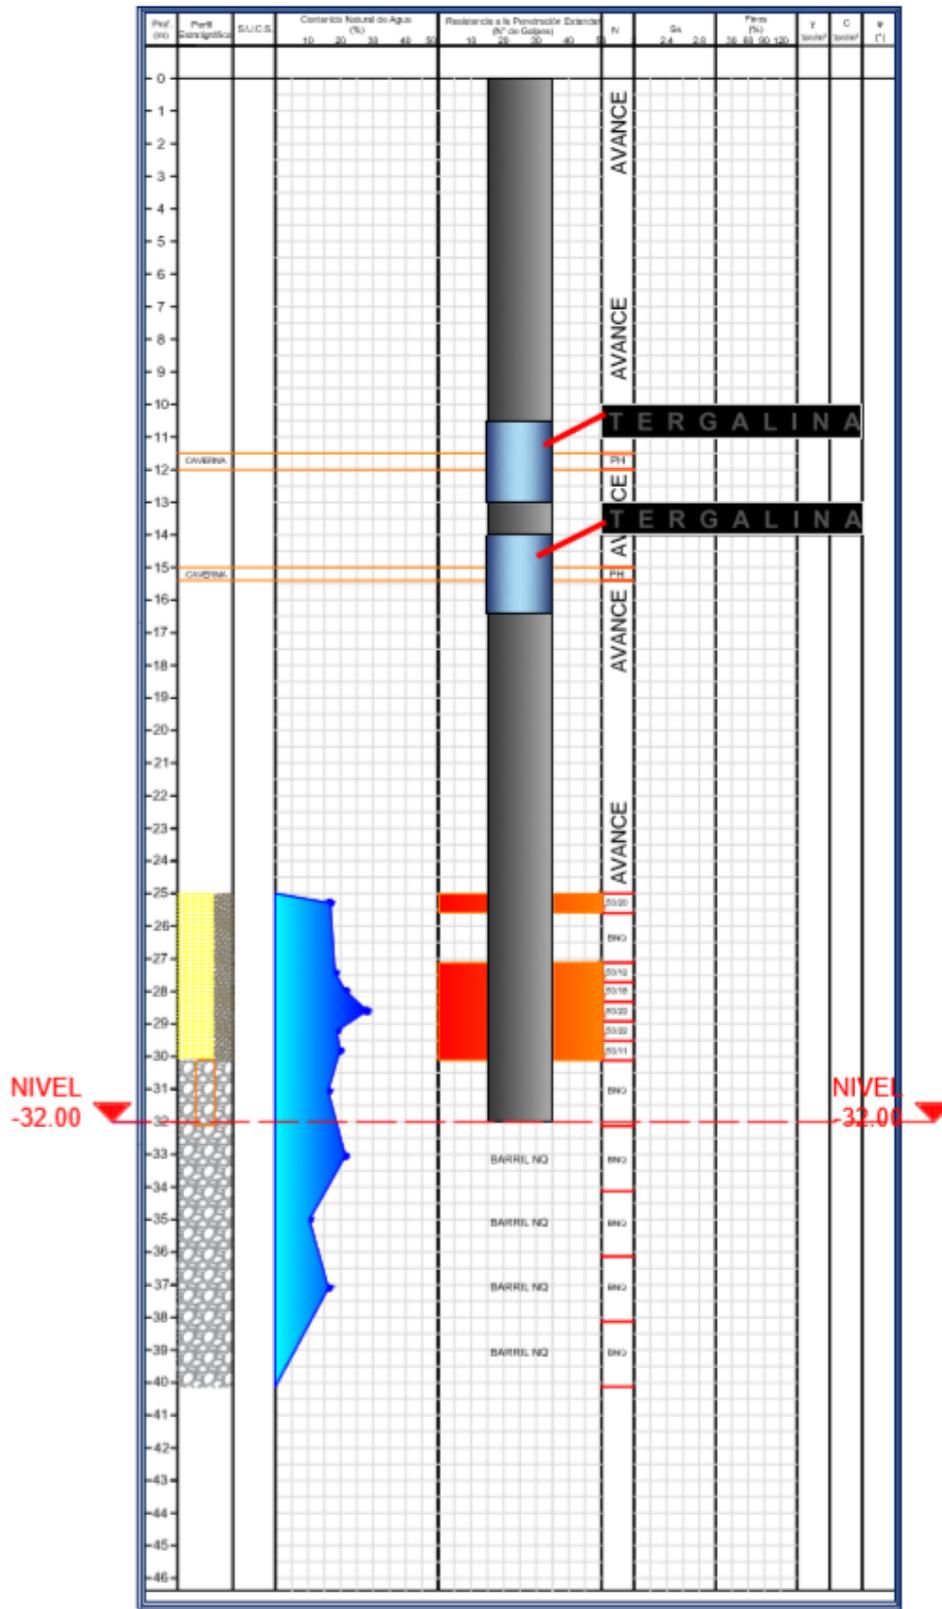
DESPLANTE DE PILA 17 (SM-9-EJE H1).
